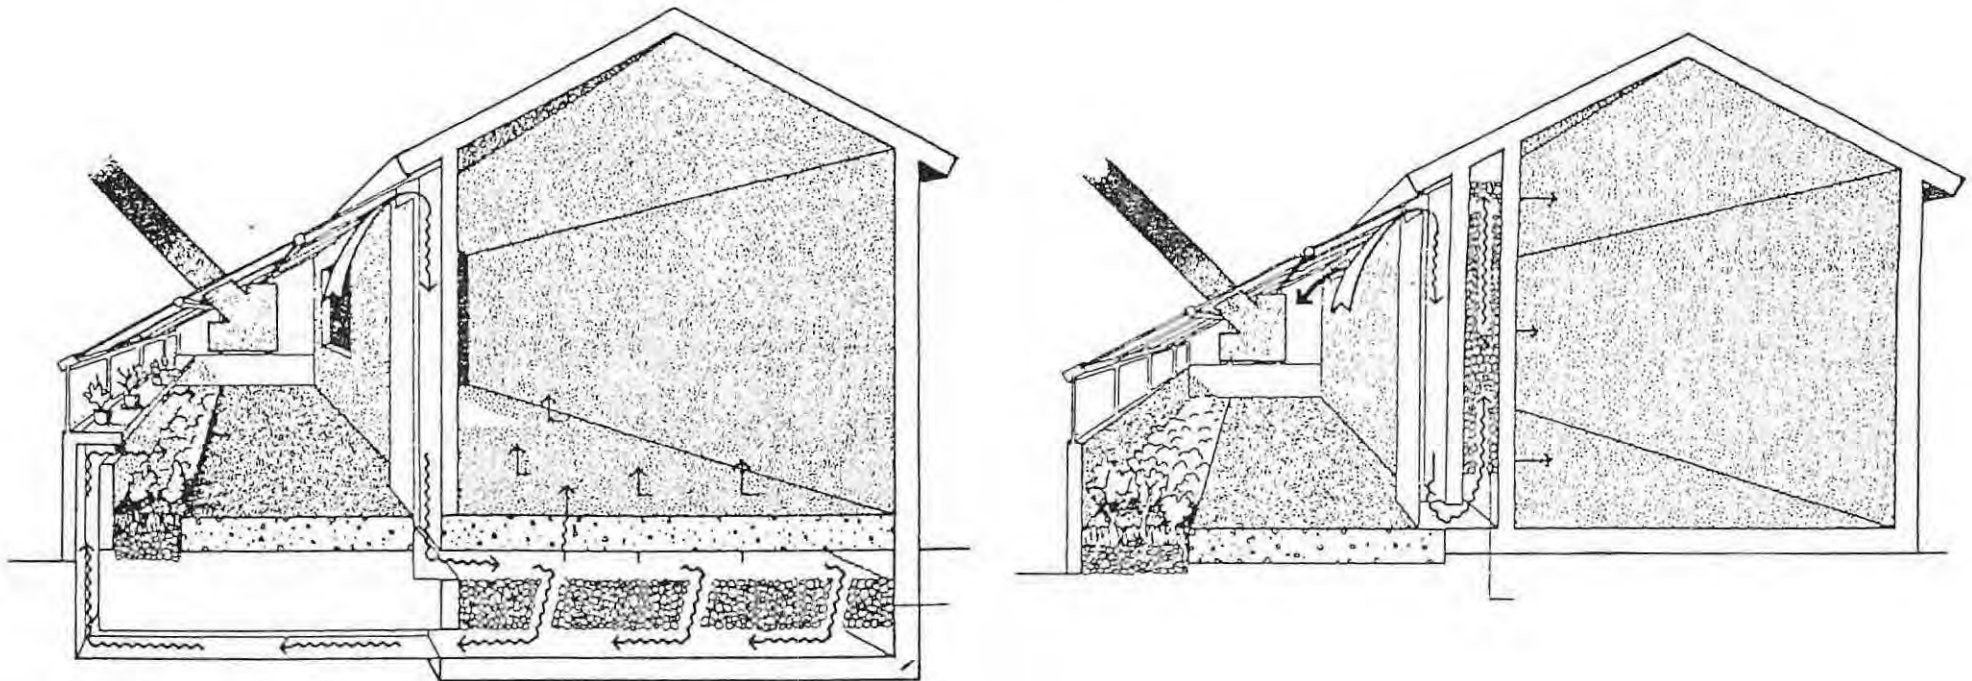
Almacenaje en piedra inducido por ventiladores.
